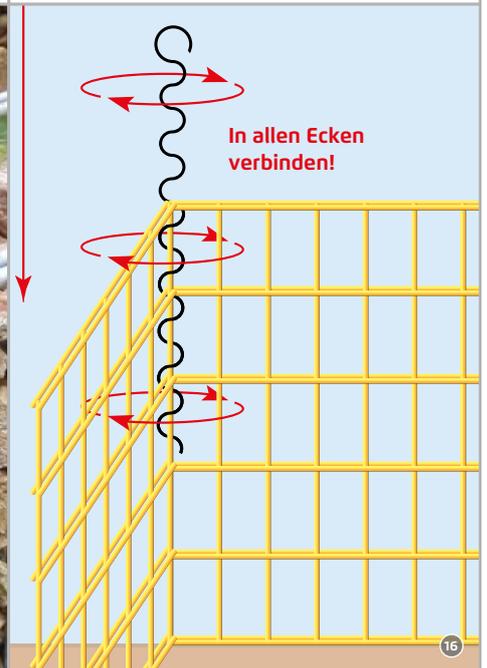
© Drahtwaren Driller GmbH
